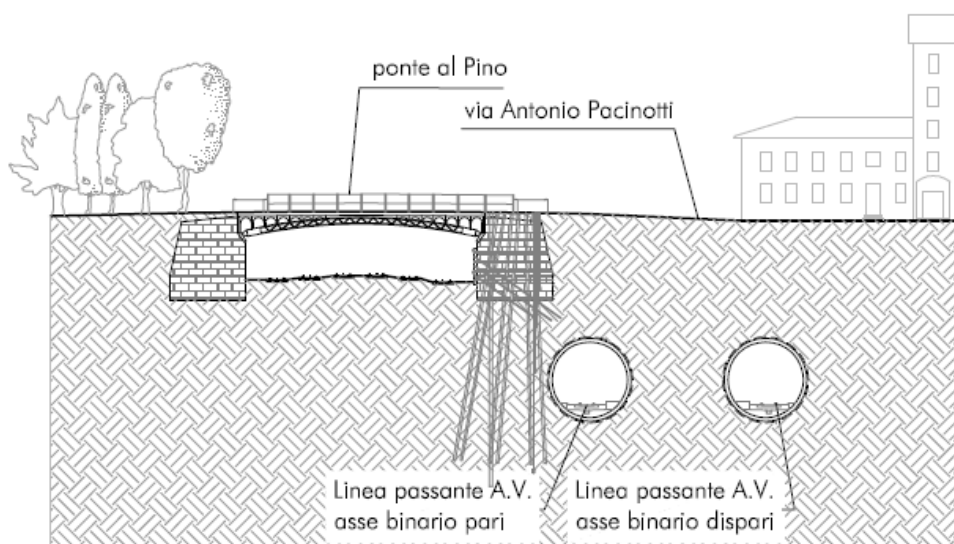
Il Ponte al Pino con le gallerie dell'AV
